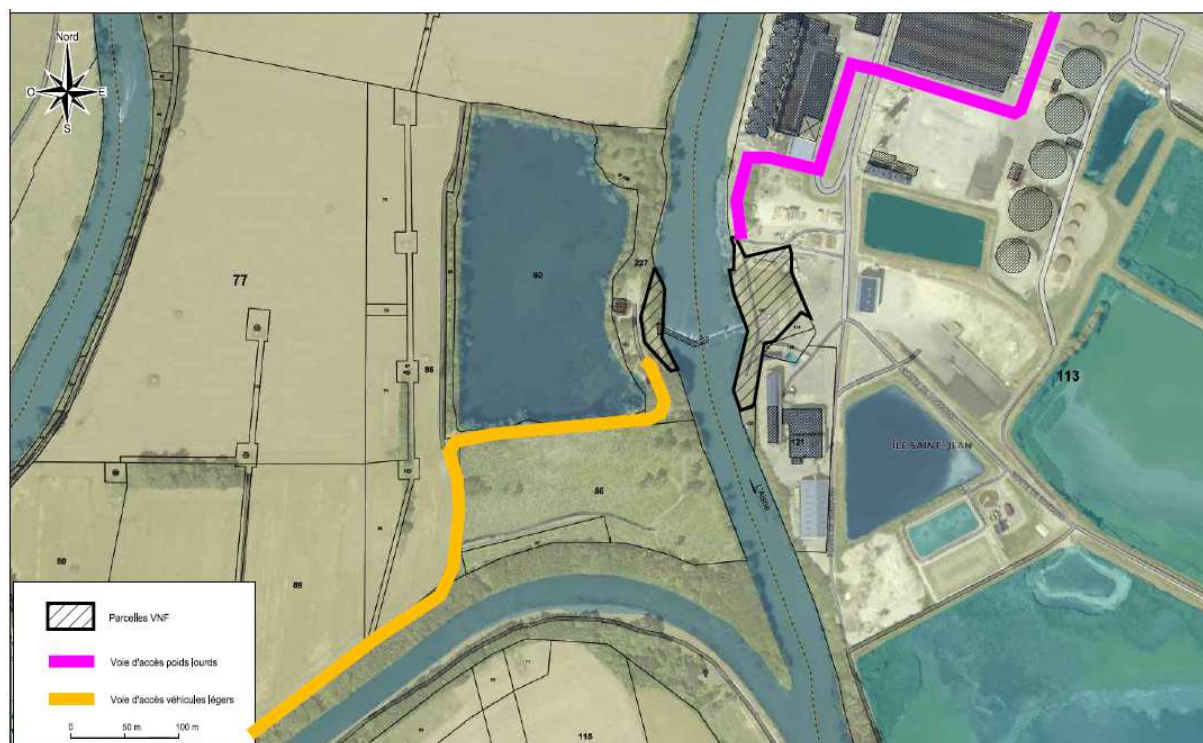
Plan d'accès au barrage – Plans ARTELIA (2014)
